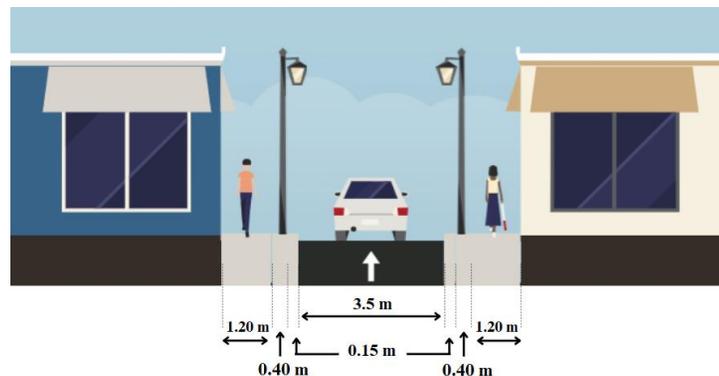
Propuesta de creación de banqueta con ancho de calzada de siete m
